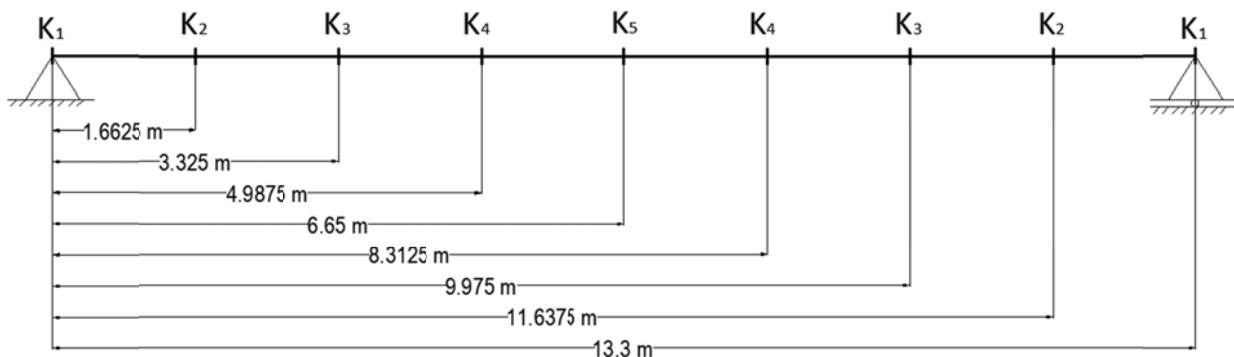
Sektionet ne te cilin do te ndërtohen vijat influente për traun me gjatësi 13.3 m
